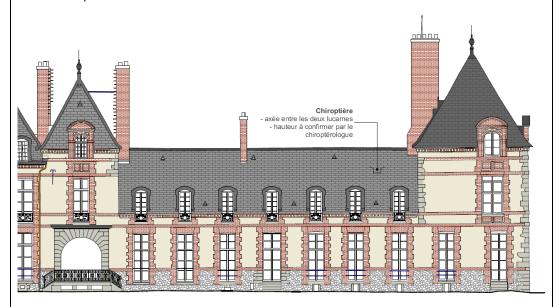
Façade sud de l'aile sud du château avec position de la chiroptière en toiture
